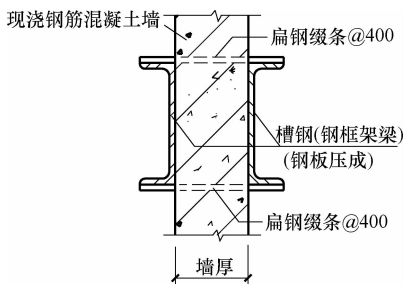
钢框架“双梁”中的现浇钢筋混凝土抗震墙
